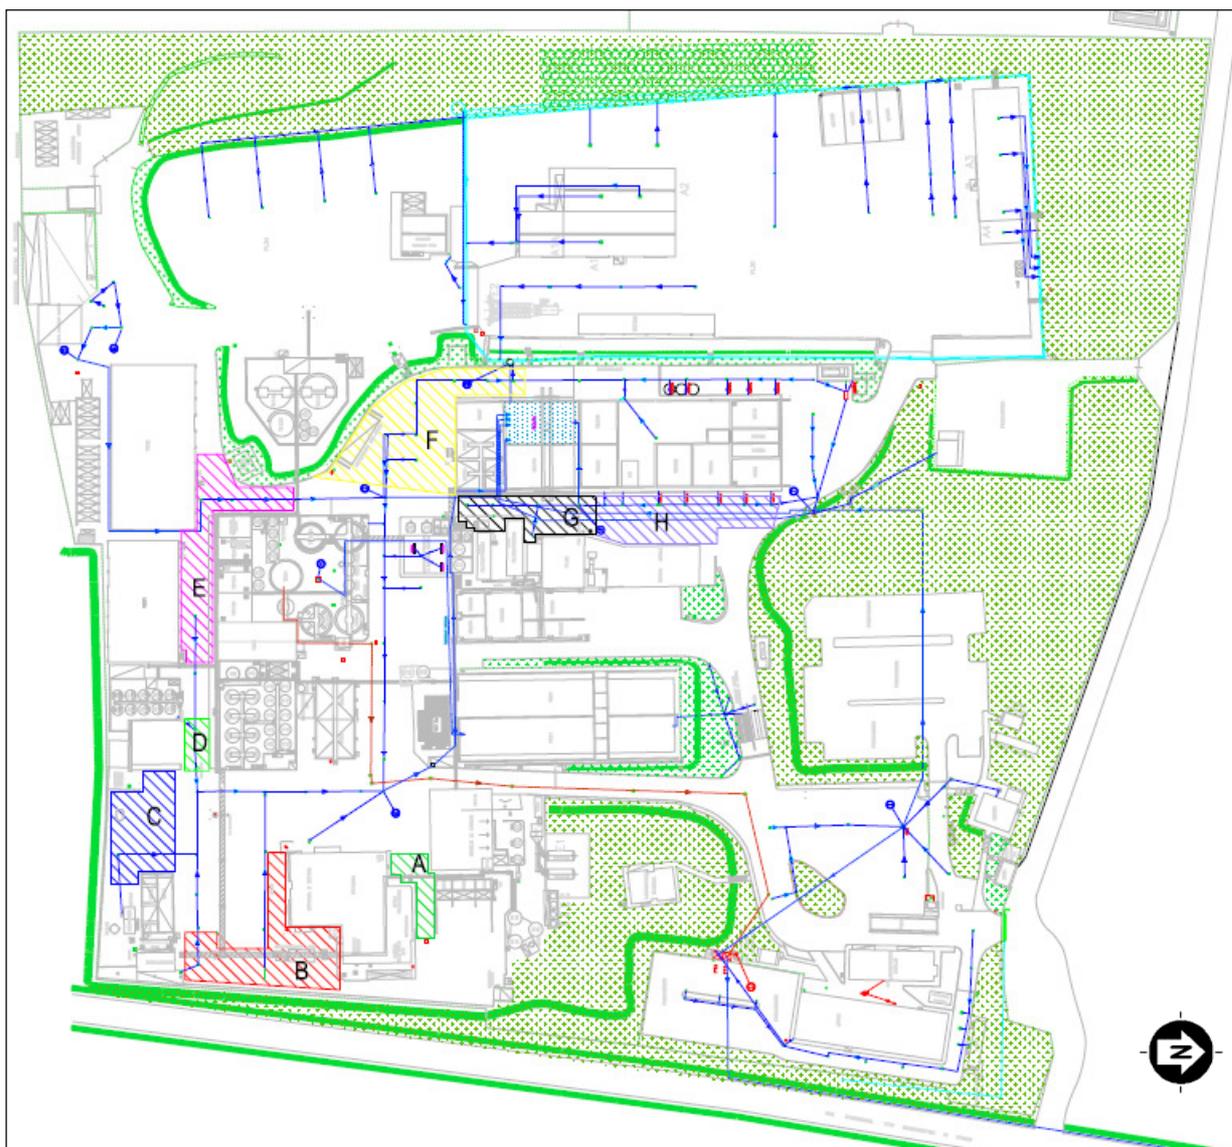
Planimetria rifacimento pavimentazione periodo 2006-2007
